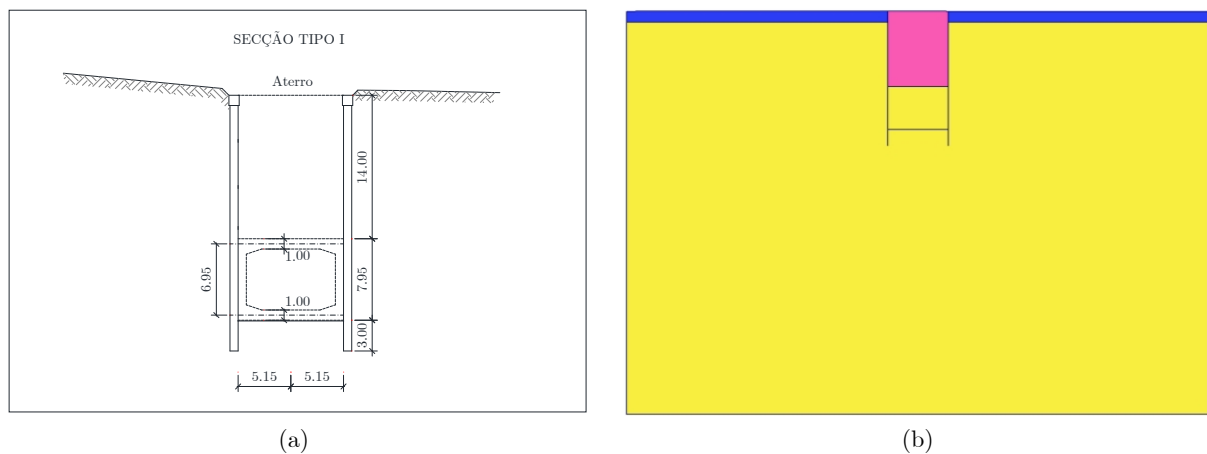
Cortes transversais: (a) Modelo 1 – corte transversal tipo; (b) Modelo estrutural executado no PLAXIS.
